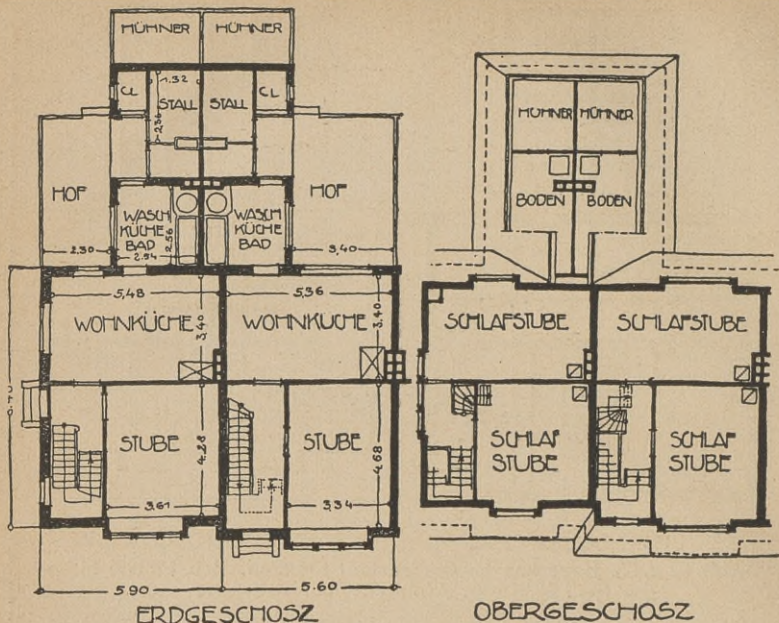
u. 67. Haus von 5,60 m Front der Siedlung Friesland in Emden. Beb. Fläche des Mittelhauses 47,04 qm, des Stalles 18,85 qm. Architekt Muthesius
